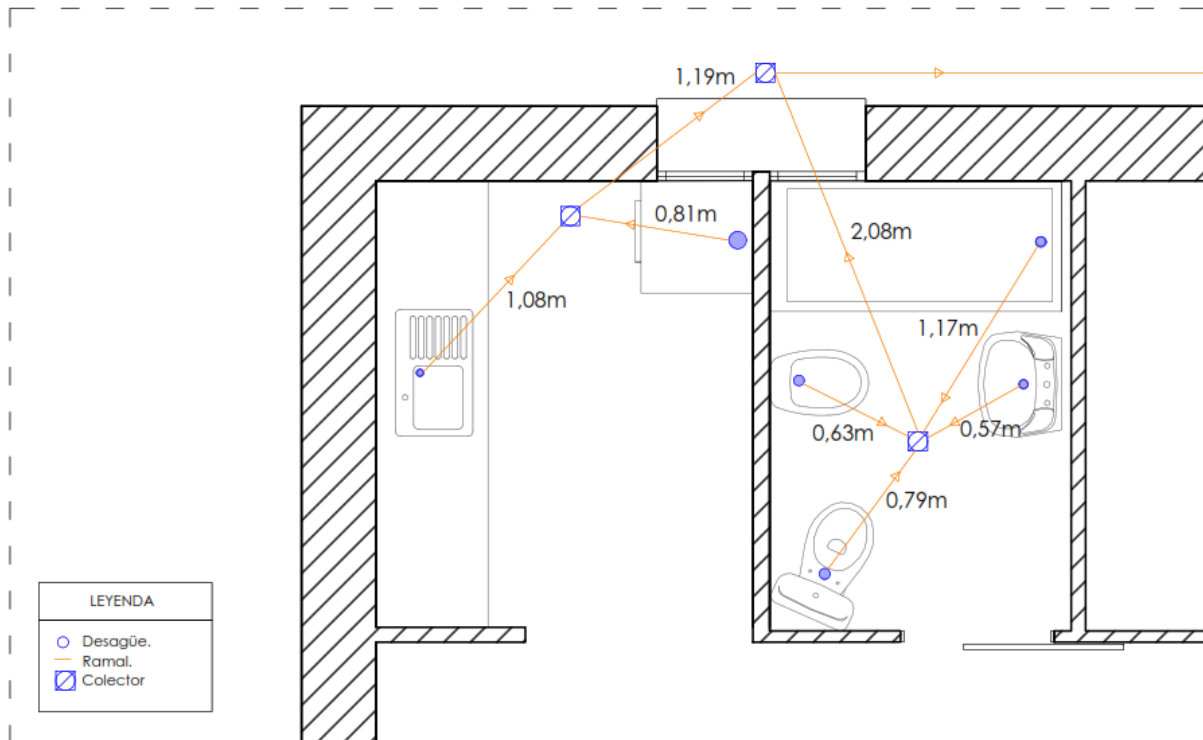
Red de saneamiento de la vivienda 969, estado reformado.
